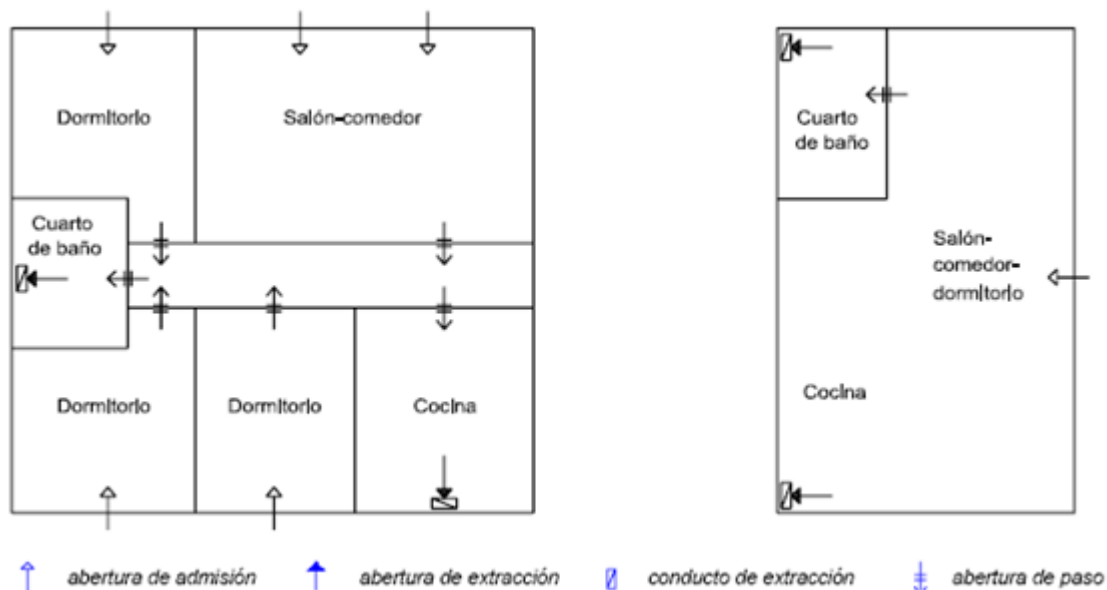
Ejemplos de ventilación en interior de las viviendas
